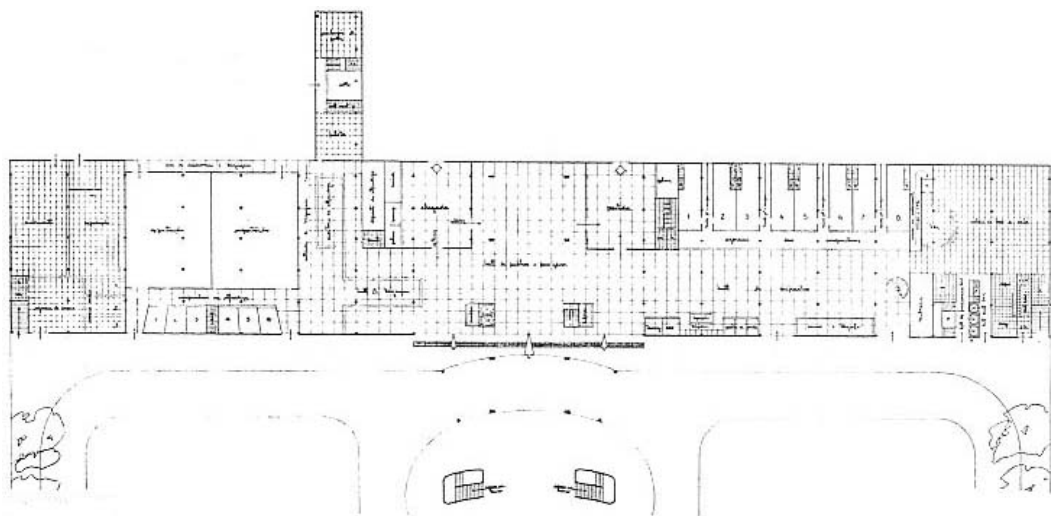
Anteprojeto de José Teódulo da Silva - planta baixa do pavimento térreo.
